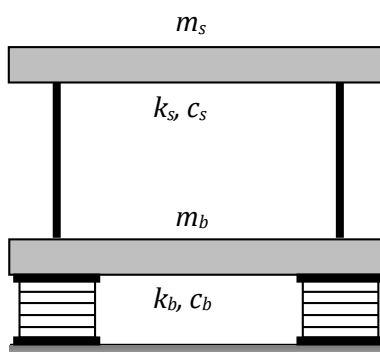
Estructura de un nivel con aislamiento sísmico
